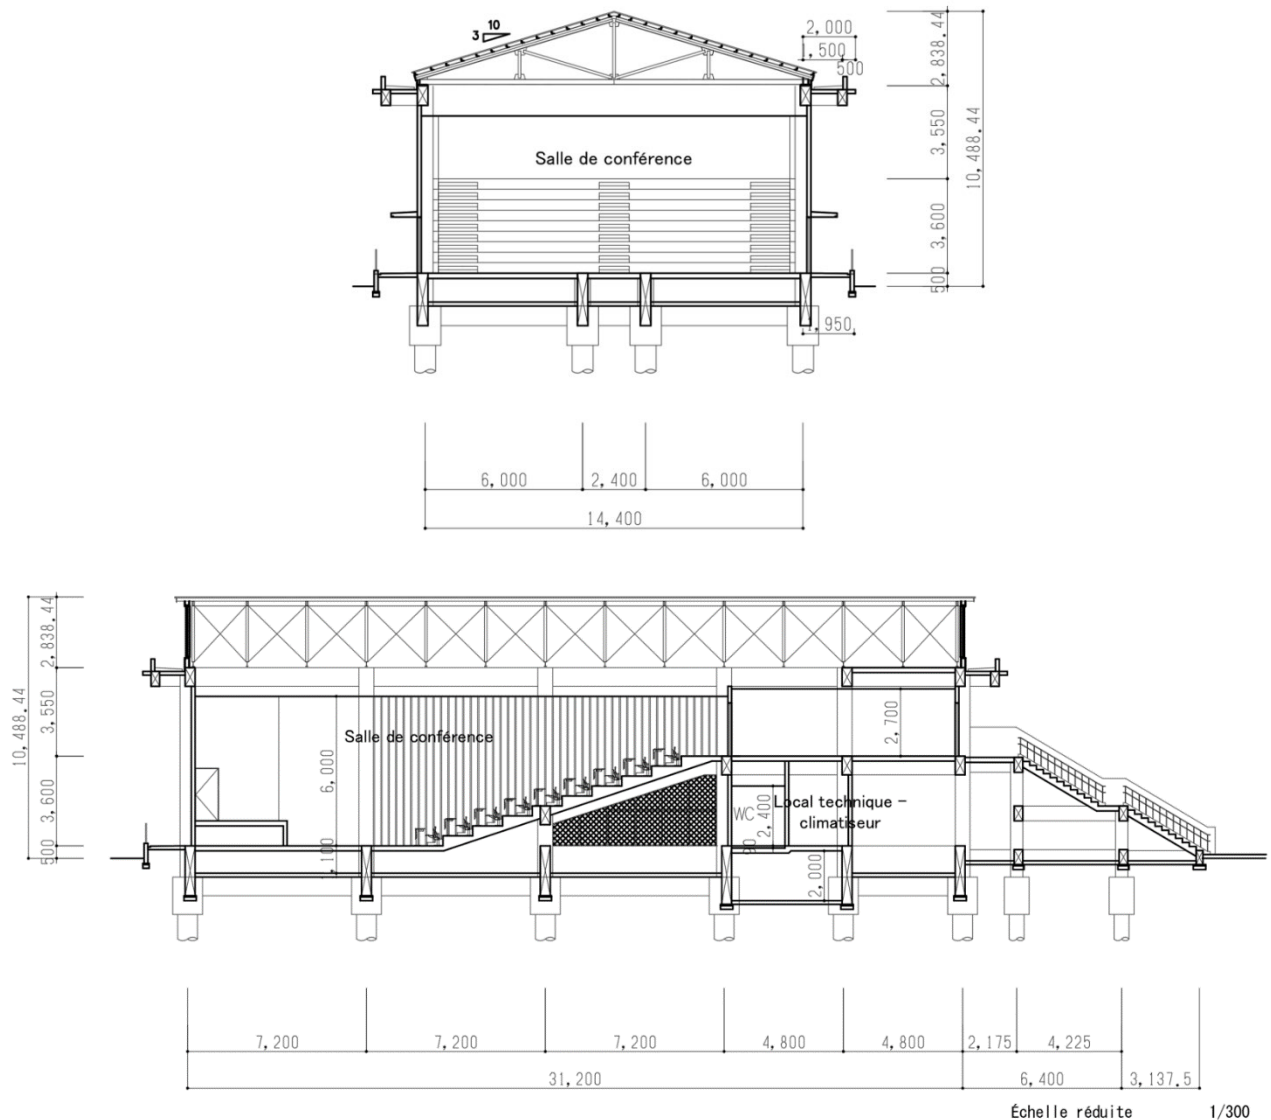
Coupe transversale du bâtiment polyvalent
